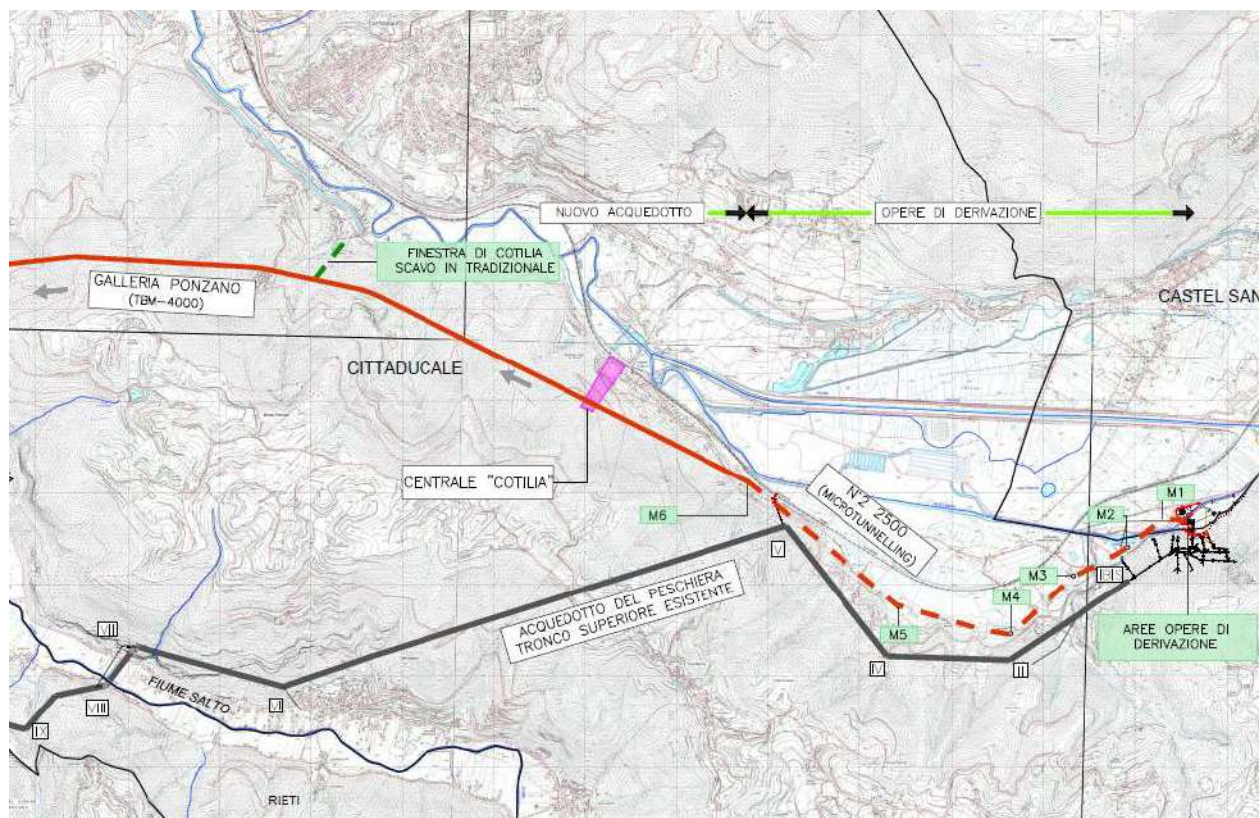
Ubicazione del Manufatto NMP – vista planimetrica
